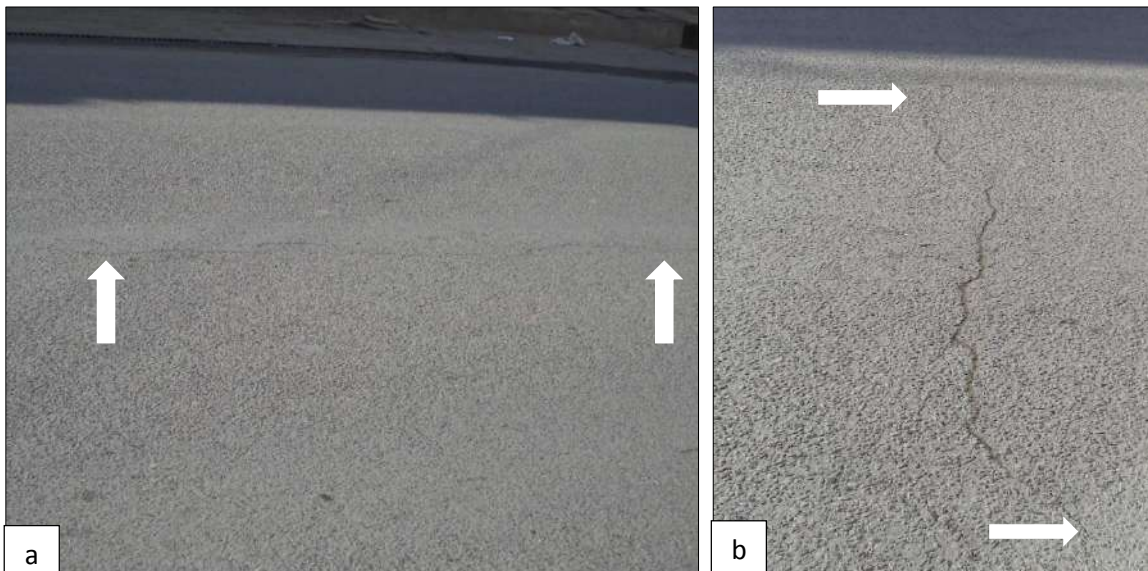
Fisuras longitudinales (a), transversales (b) de severidad bajo
